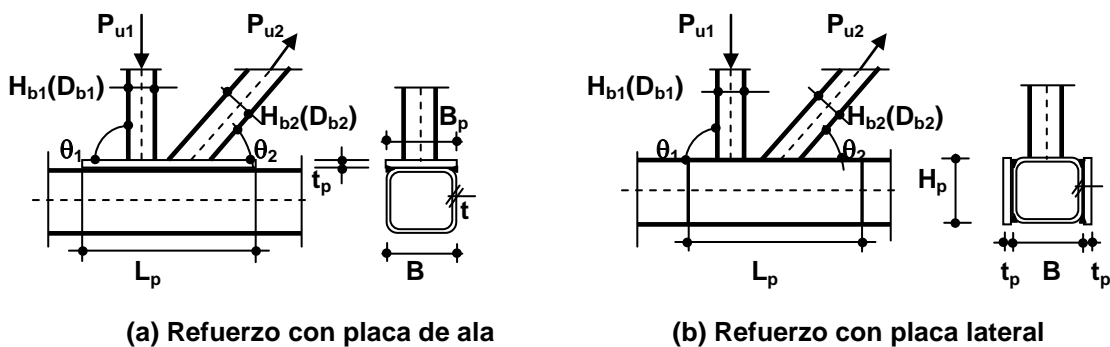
Nudo N soldado con refuerzo de placas.
